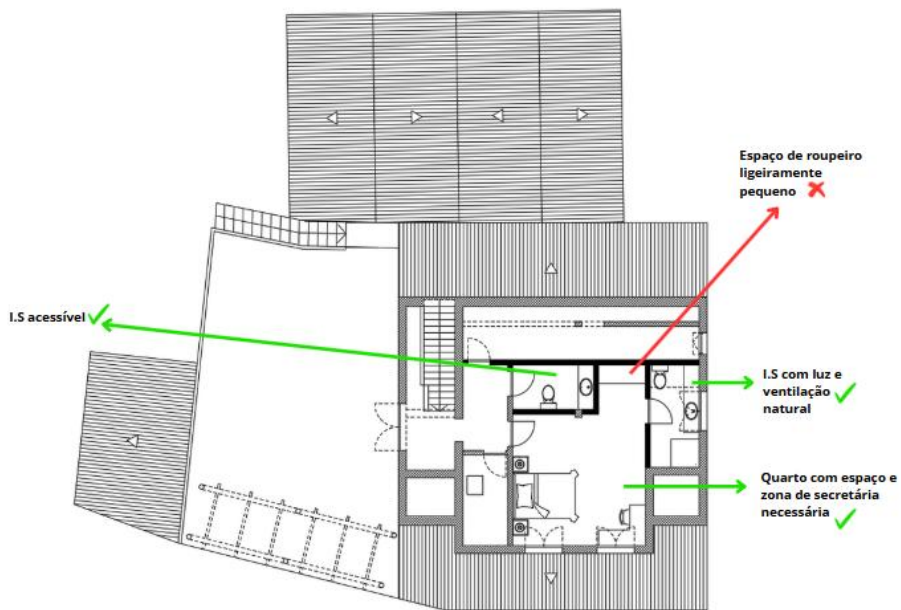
Análise de plantas esboço, proposta 1, piso 1
